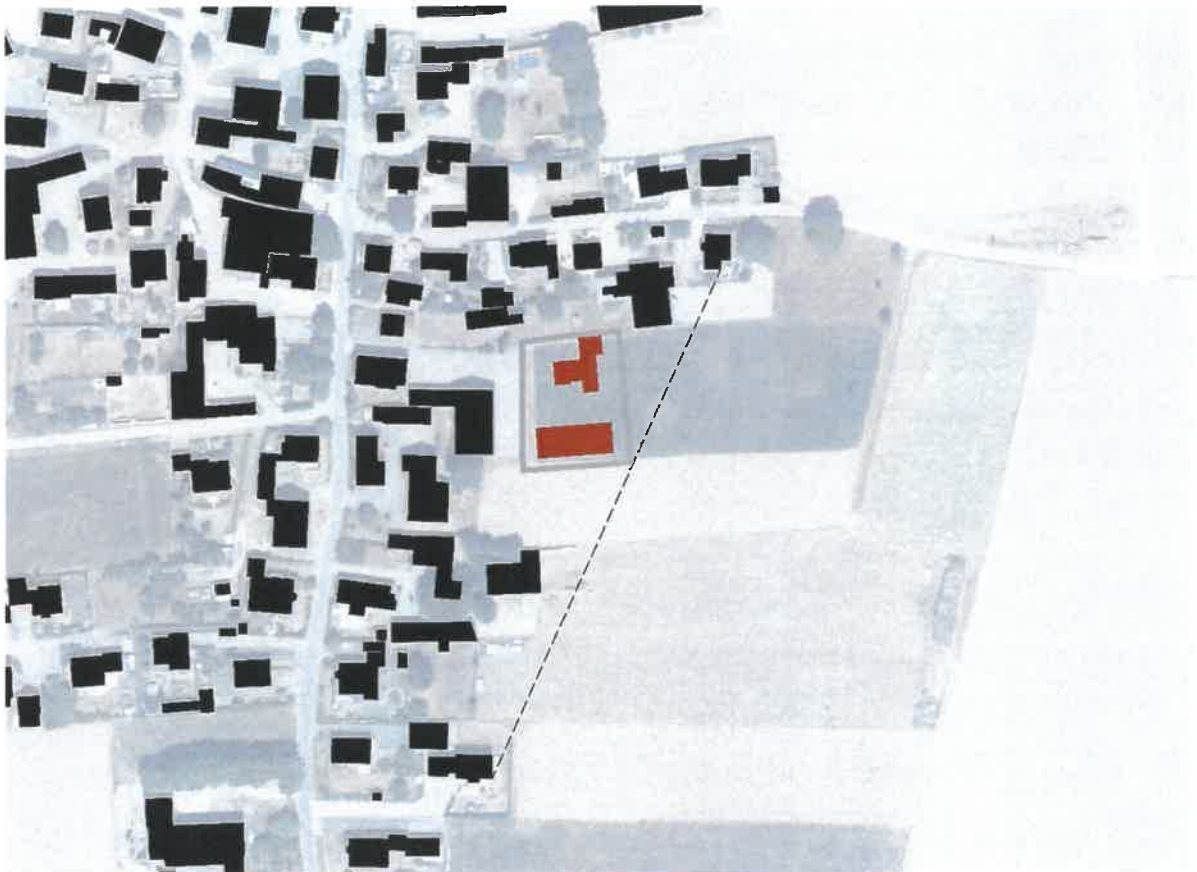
Schwarzplan für den Ortsteil Aschbuch mit Bebauungsvorschlag innerhalb der Einbeziehungssatzung
